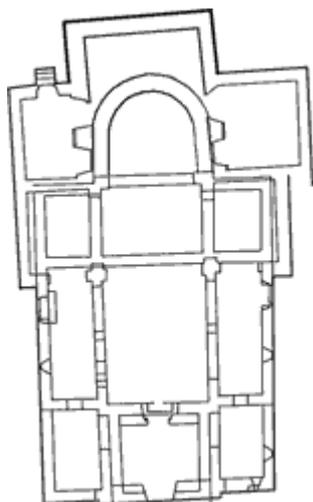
Planta da Igreja de San Juan de Pravia.
